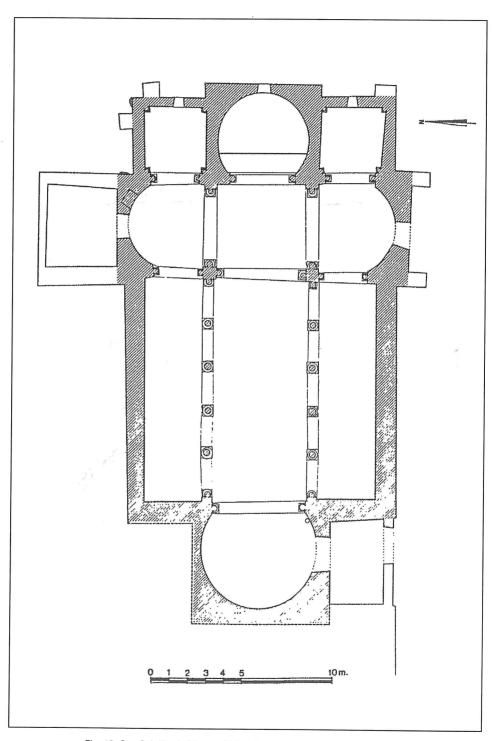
San Cebrián de Mazote (Valladolid). Planta (según: Gómez-Moreno)
